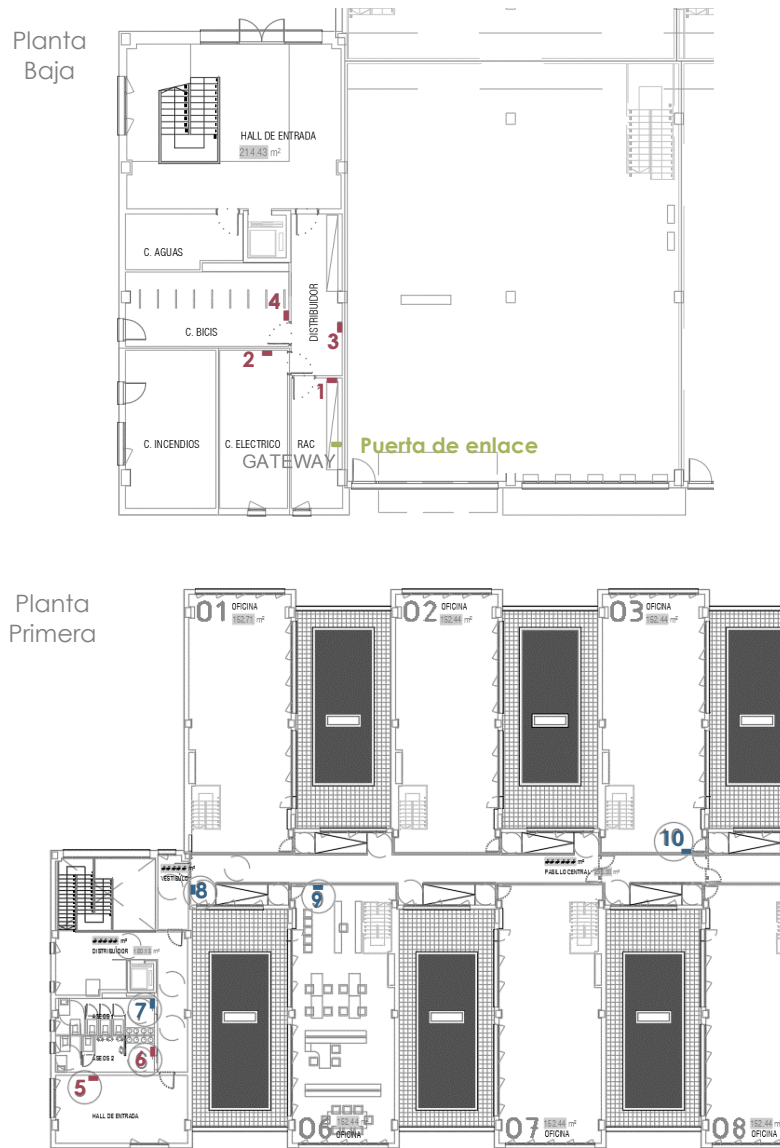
Plano de ubicación de planta baja y planta primera de los sensores de monitorización en el edificio del Parque Tecnológico de Álava en Miñano (España)
